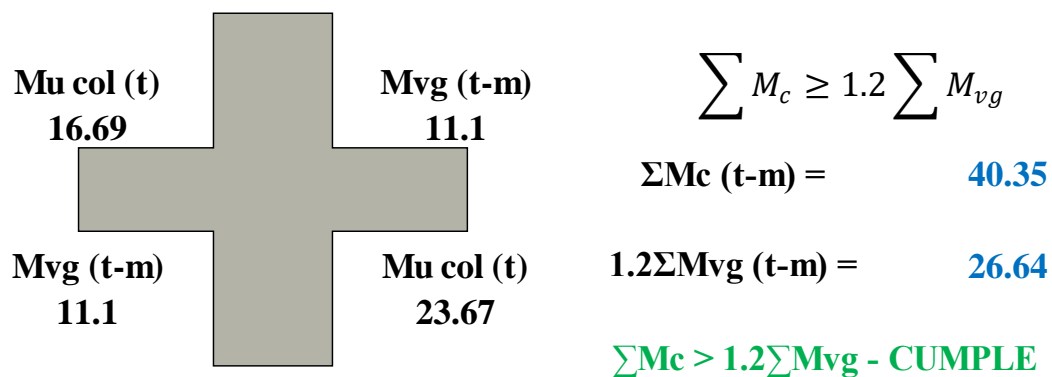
Revisión de momento para cumplir viga débil – columna fuerte en el DBDD.
